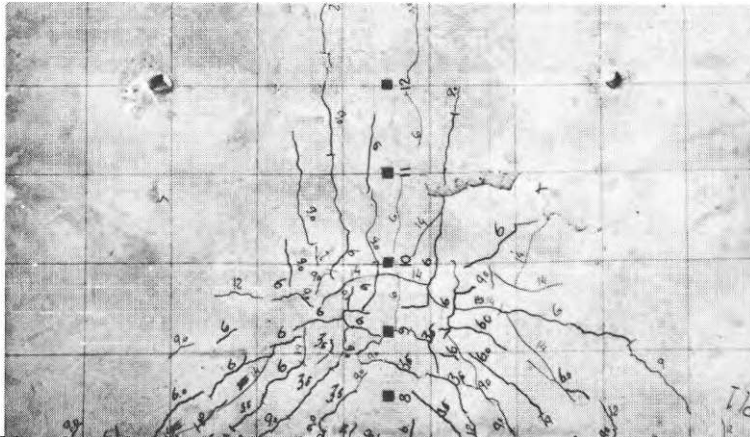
Sprickbild på plattans ovansida vid den pelare, där brott inträffade. Plattorna 8 och 9 hade den större armeringsmängden och skjuvarmering. Platta 1 saknade skjuvarmering. Rutnätet har sidan 20 cm.
